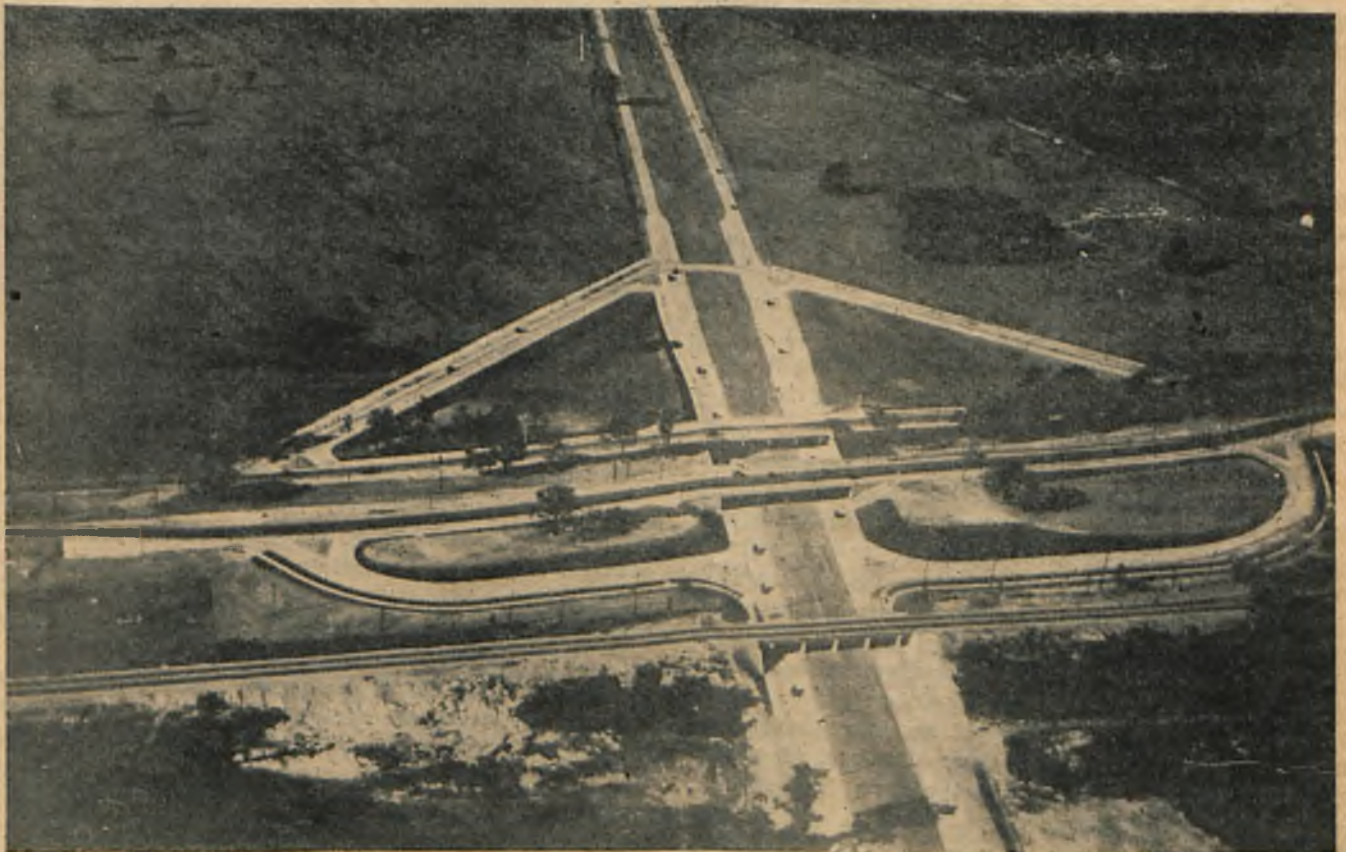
Skrzyżowanie autostrad, wybudowane w 1928 r. jest pierwowzorem konstrukcyj tego typu. Wszystkie skrzyżowania w różnych poziomach.
